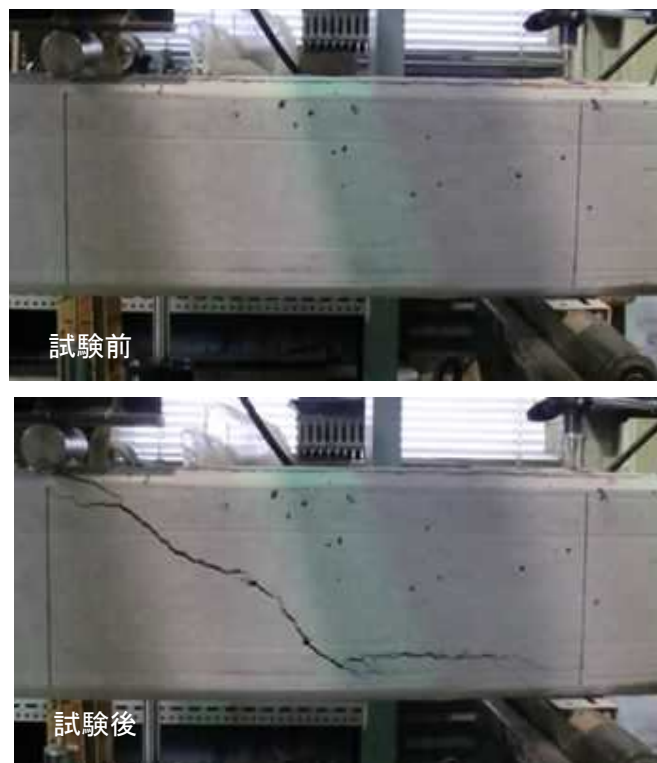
No. 1 (せん断補強無し) せん断試験状況
